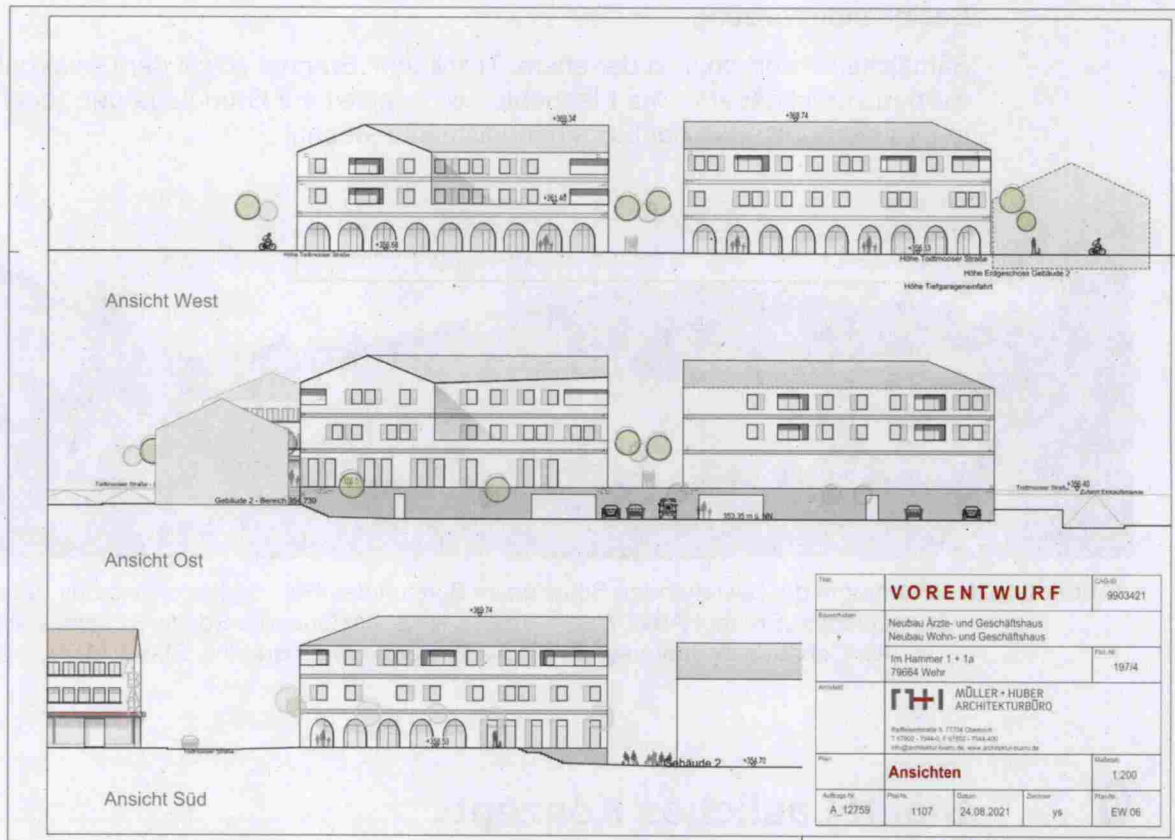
Vorentwurfsplanung Ärzte- und Geschäftshaus, Müller+Huber Architekturbüro, Oberkirch, 24.08.2021.
